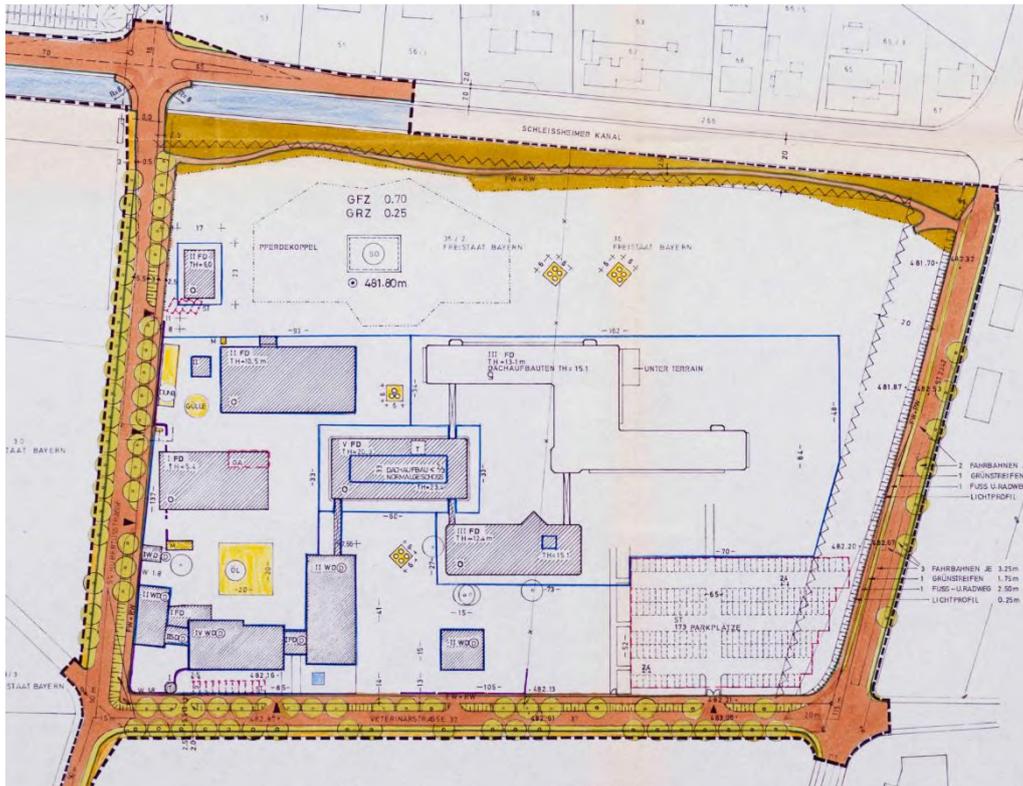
Bebauungsplan Nr. 18 der Gemeinde Oberschleißheim
